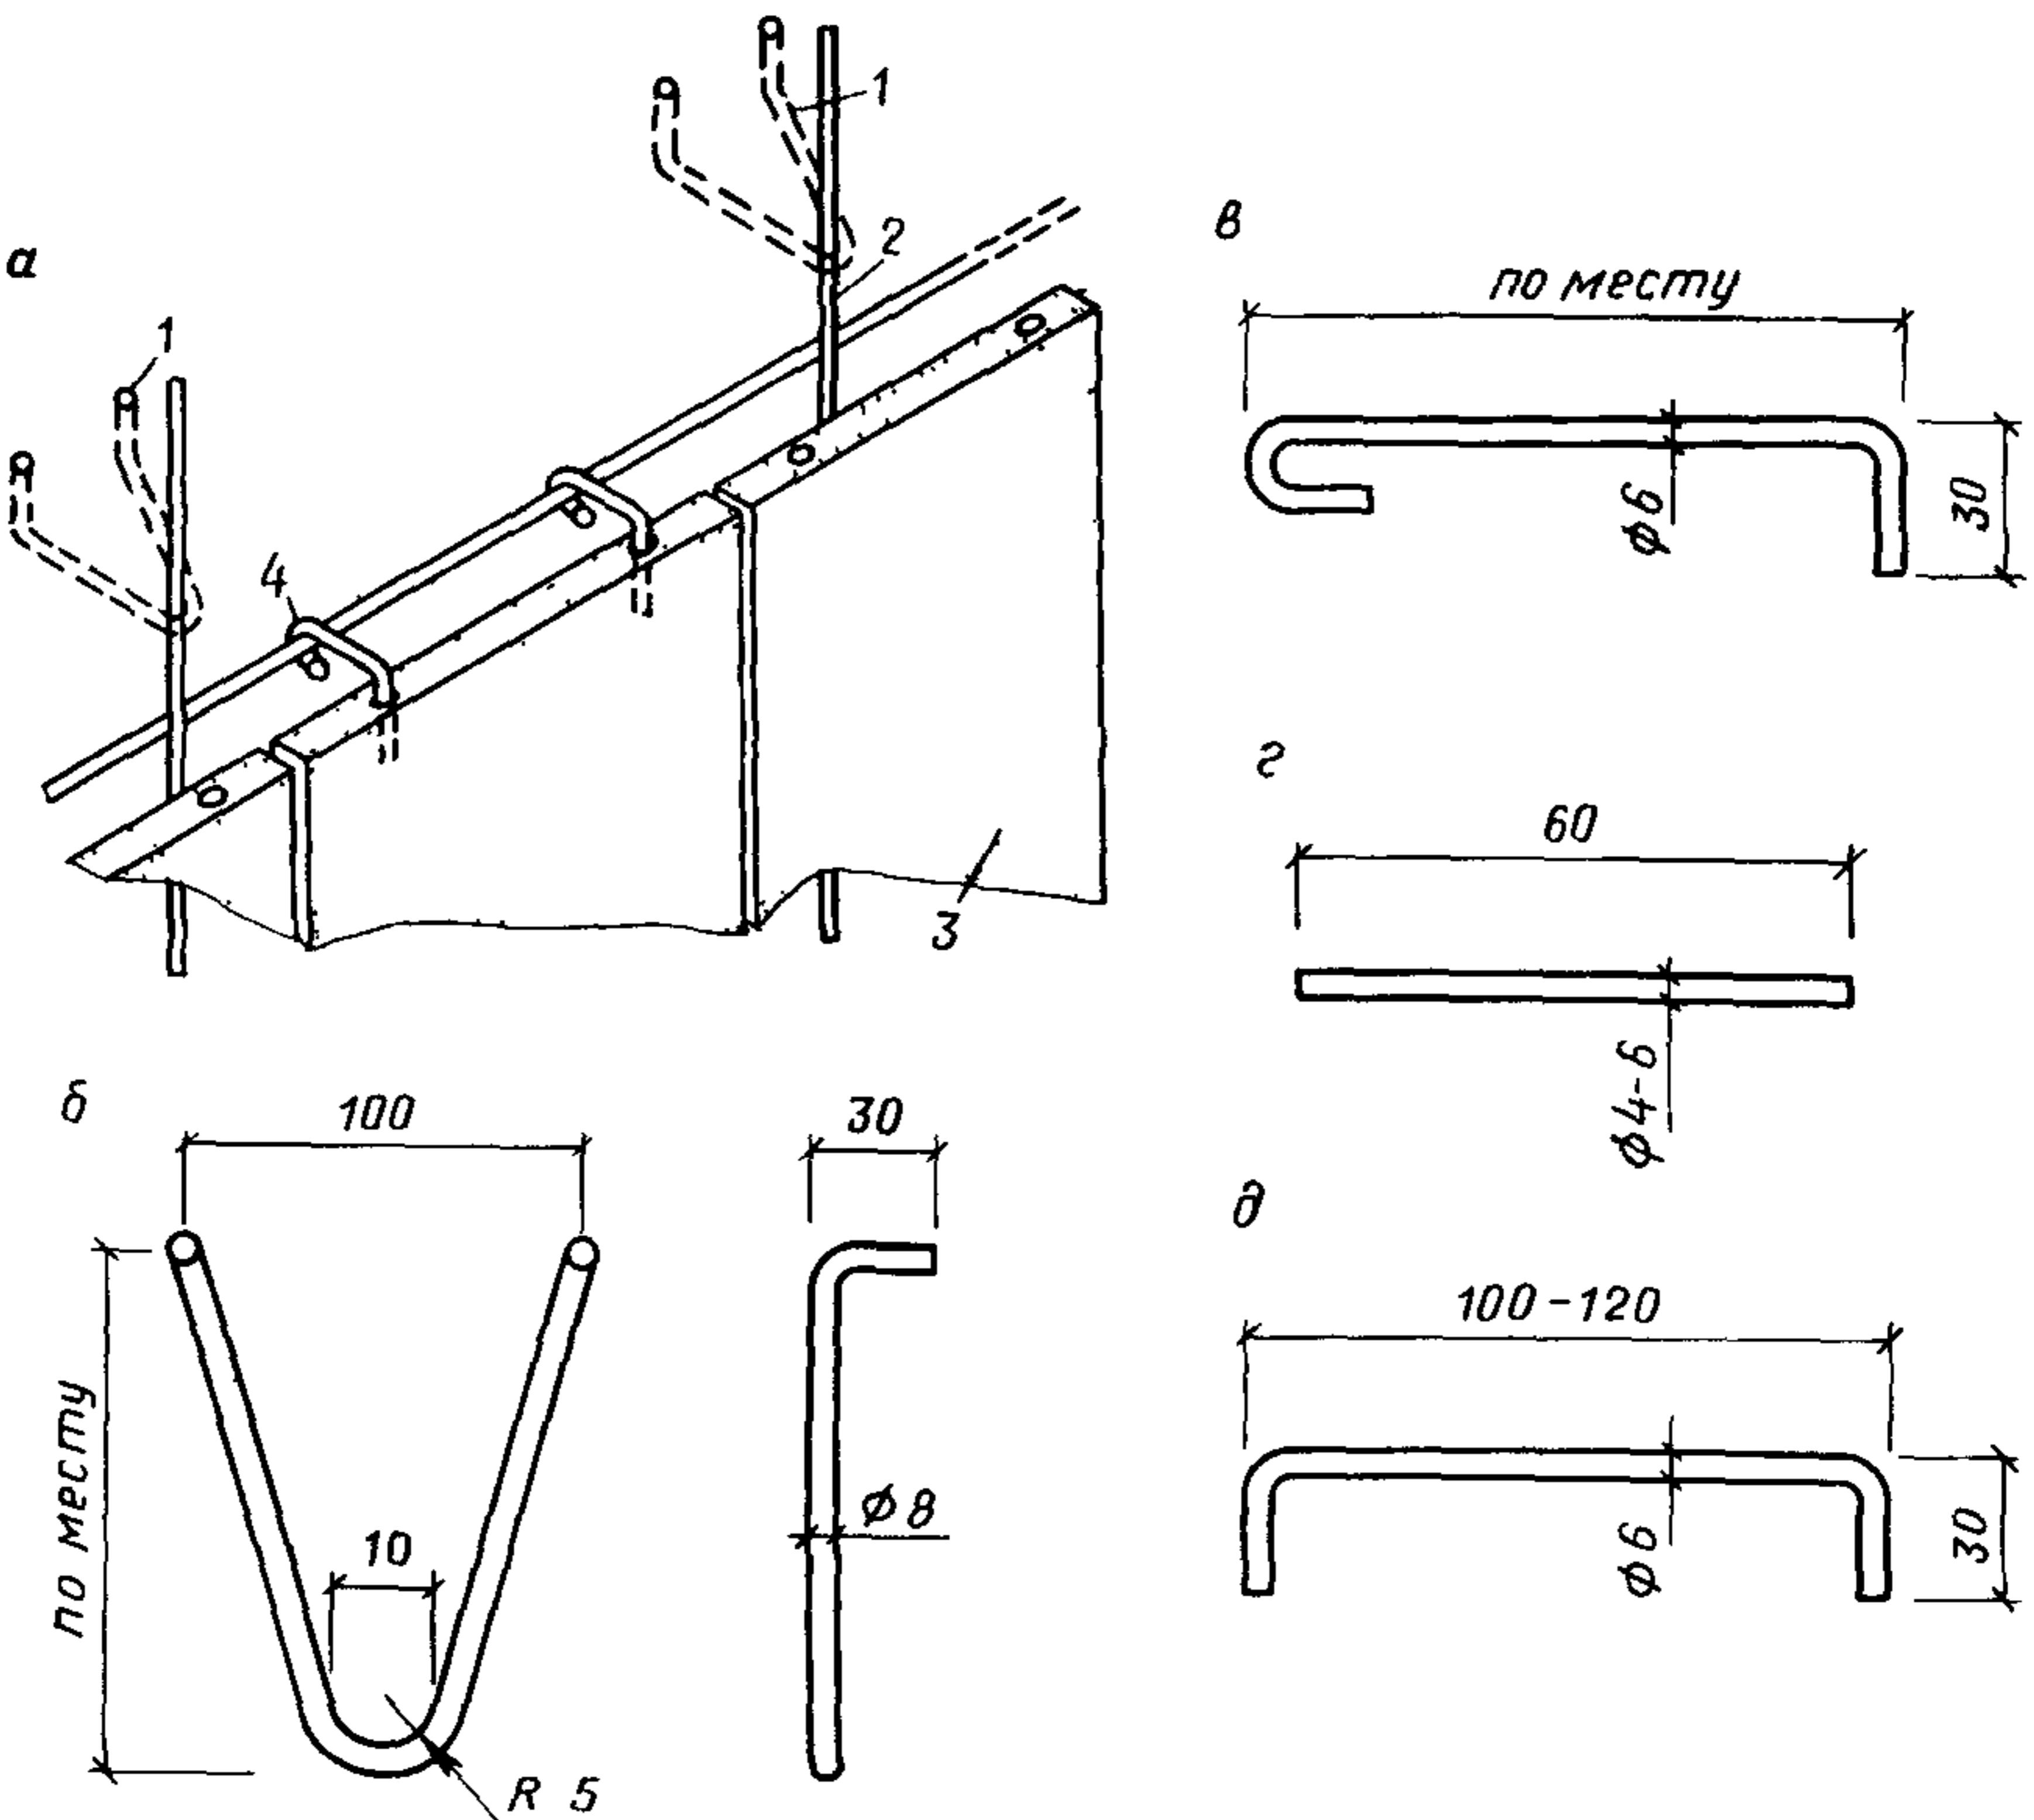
Крепление облицовочных плит при ведении работ по готовой стене
